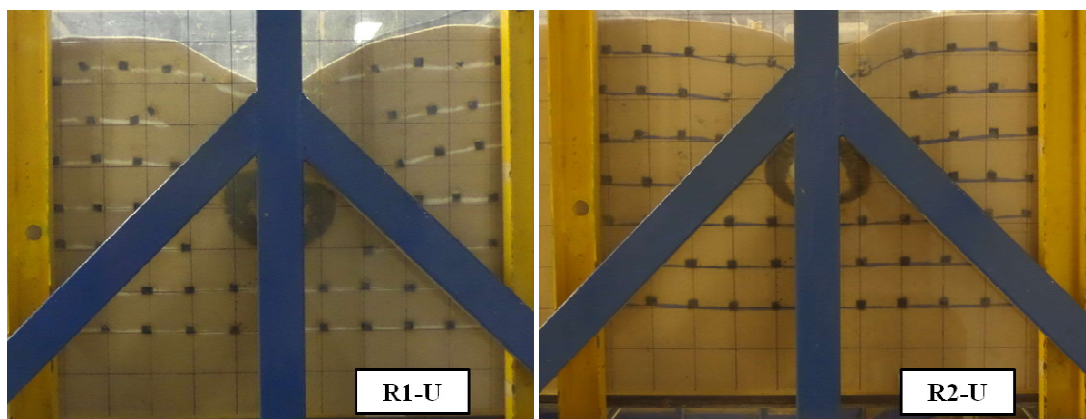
Configuração do traçado das linhas de demarcação dos ensaios.
